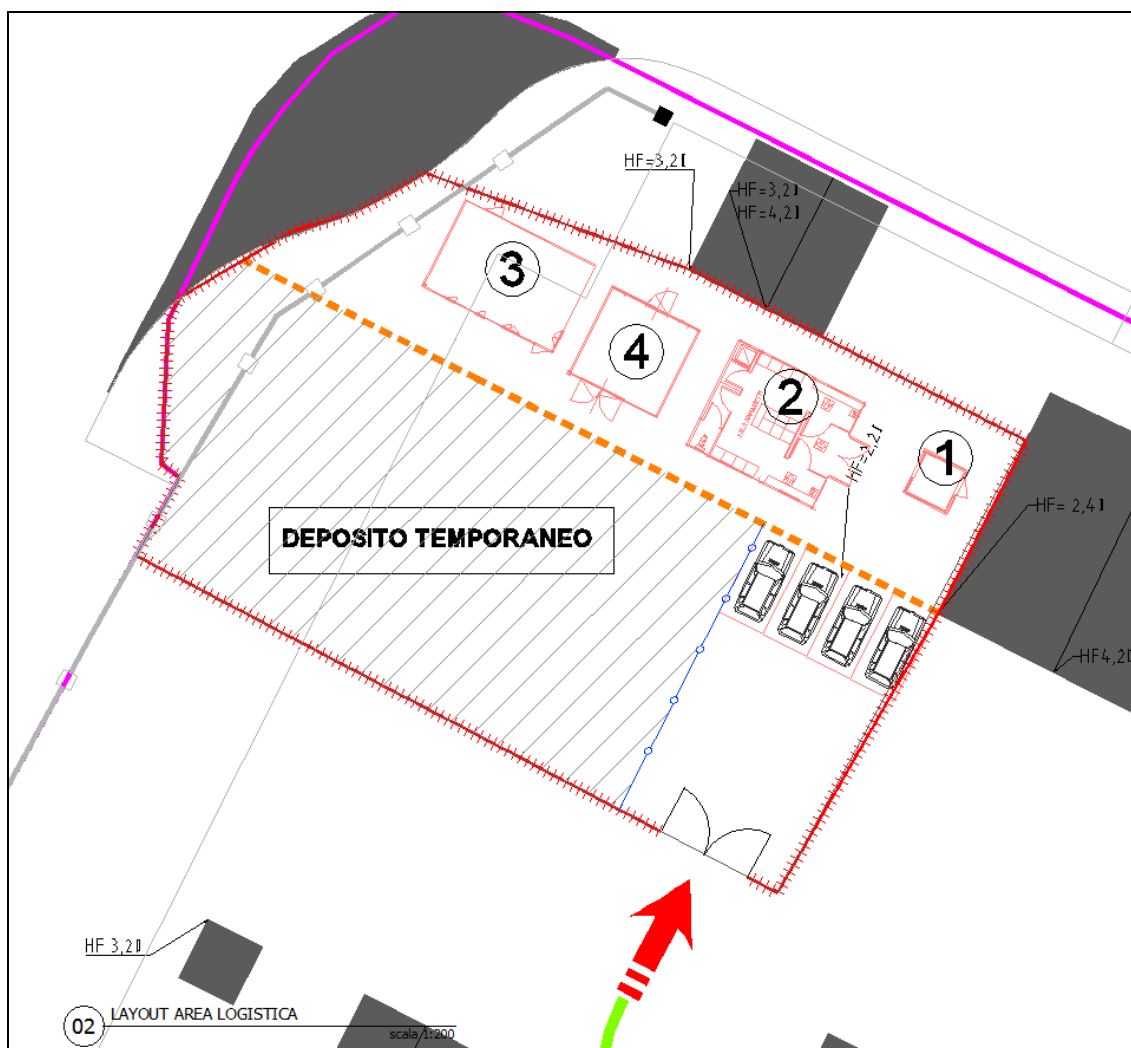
Planimetria generale Area di cantiere (stralcio)
